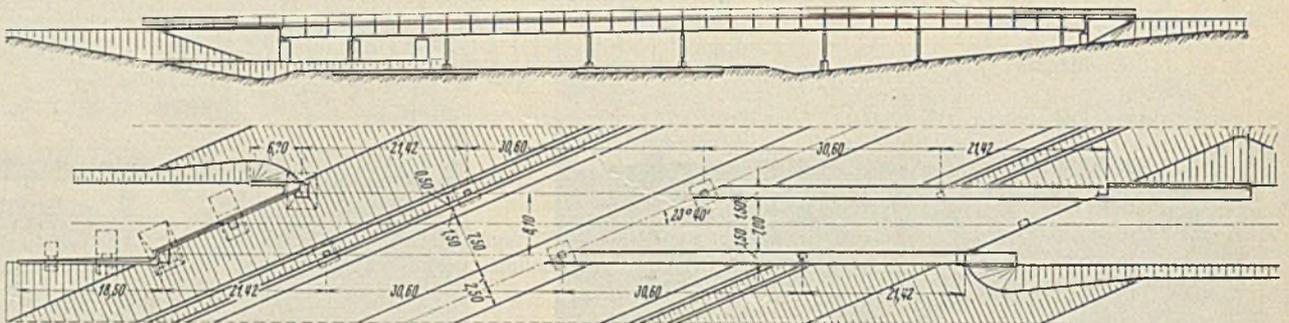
Bauwerk 67, Grundriß und Draufsicht.
